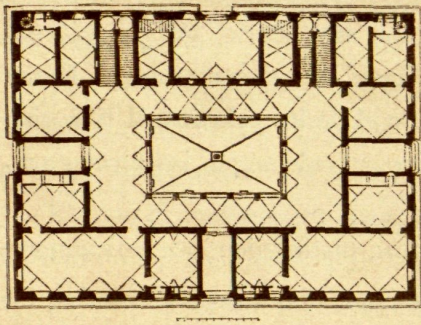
PLANTA DEL PALACIO STROZZI,
